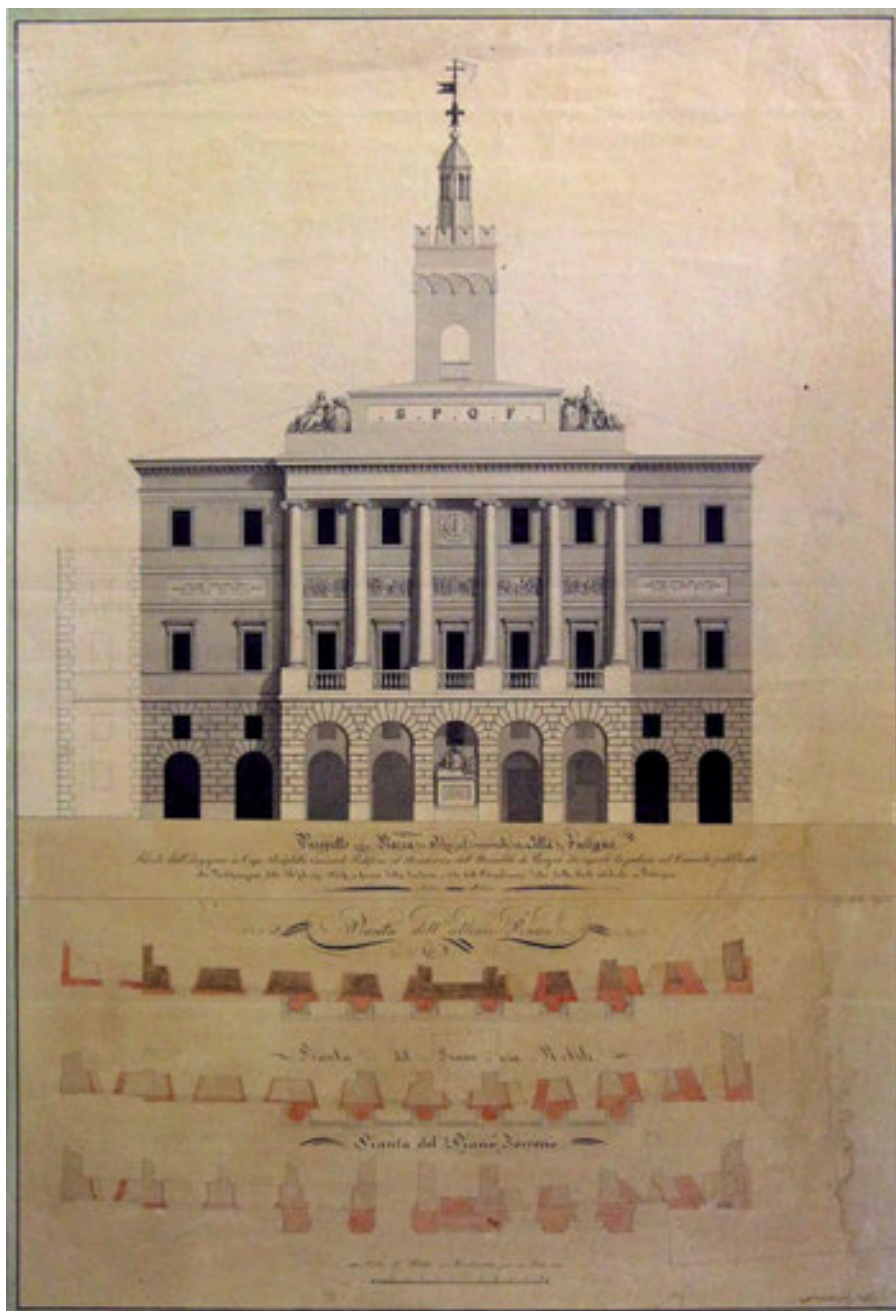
Antonio Mollari, *Prospetto sulla piazza del Palazzo Comunale della Città di Foligno ideato dall'Ingegnere in Capo Architetto Camerale Pontificio ed Accademico dell'Università di Perugia, che riportò la palma del Concorso pubblicato colla Notificazione delli 26 febbrajo 1834, a forma della decisione, e voto dell'Accademia delle Belle Arti residente in Bologna, 1834, BCF, X, 15/3.
